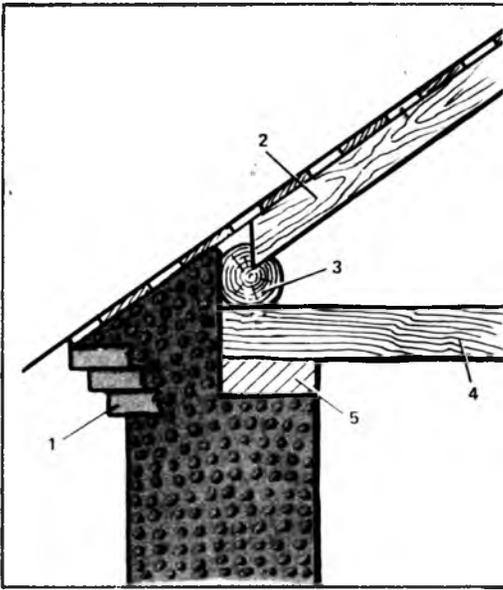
Крыша дома: 1 — кирпичи карниза; 2 — стропило; 3 — обвязка; 4 — балка-матица; 5 — бетонная площадка под балку-матицу
